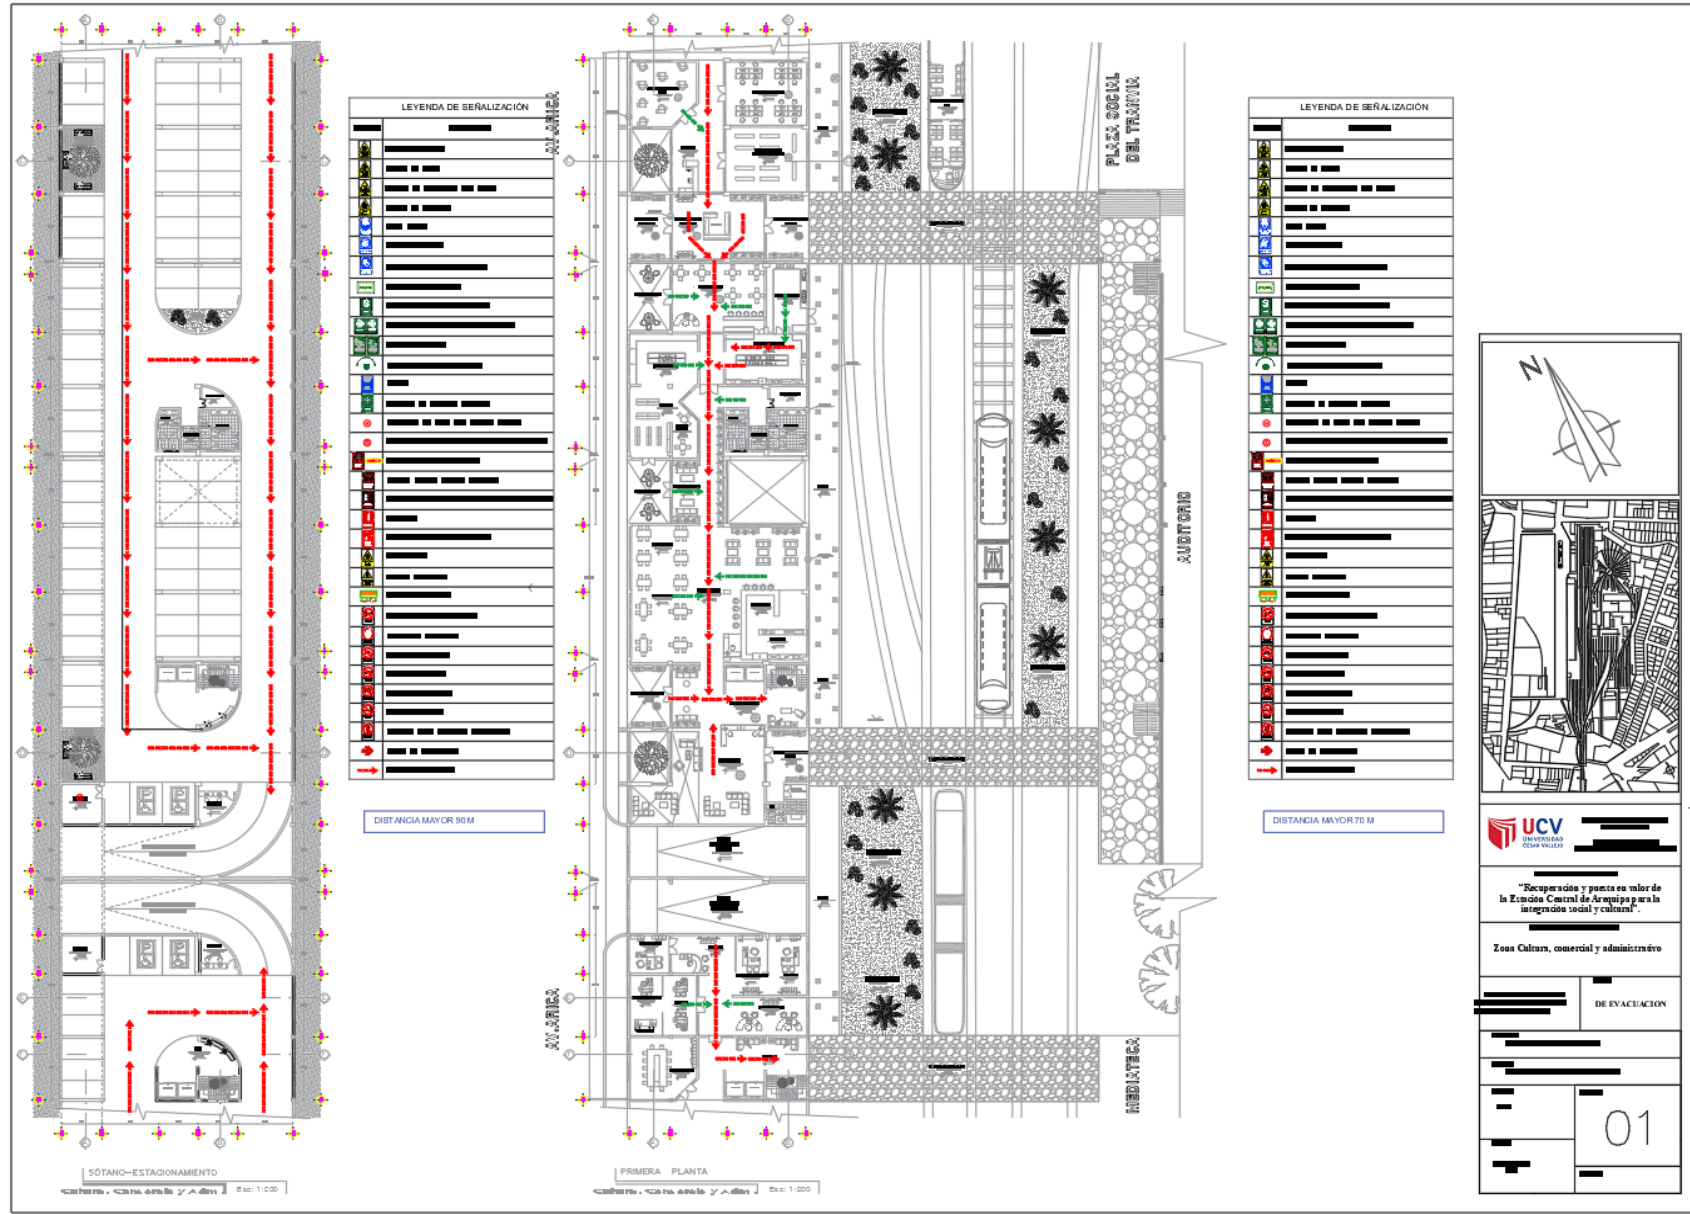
Plano de Evacuación – SÓTANO Y PRIMERA PLANTA
